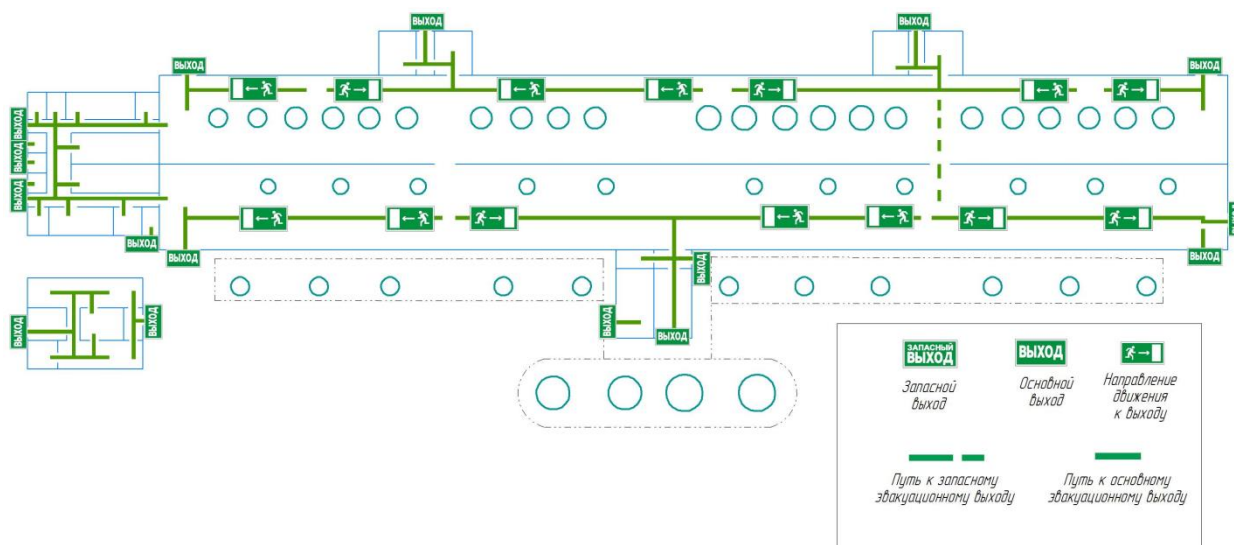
Схема эвакуации из корпуса №502 цеха №5
